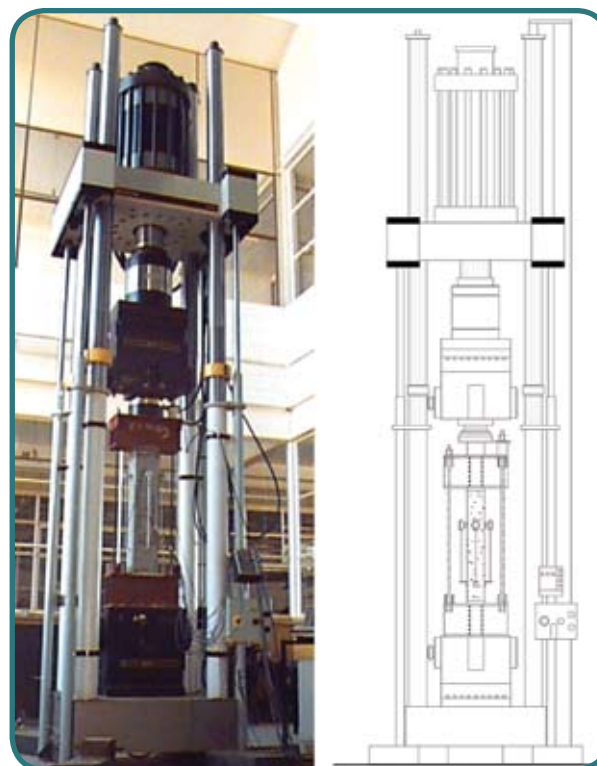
Ensaio final de pilar pré-carregado na Máquina Universal
